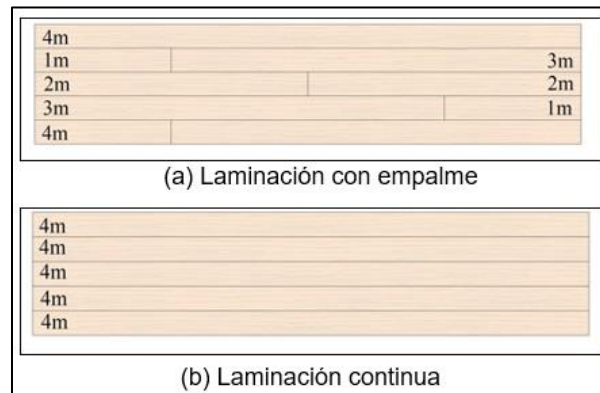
Detalle viga de laminación con empalme (a) y laminación continua (b)
